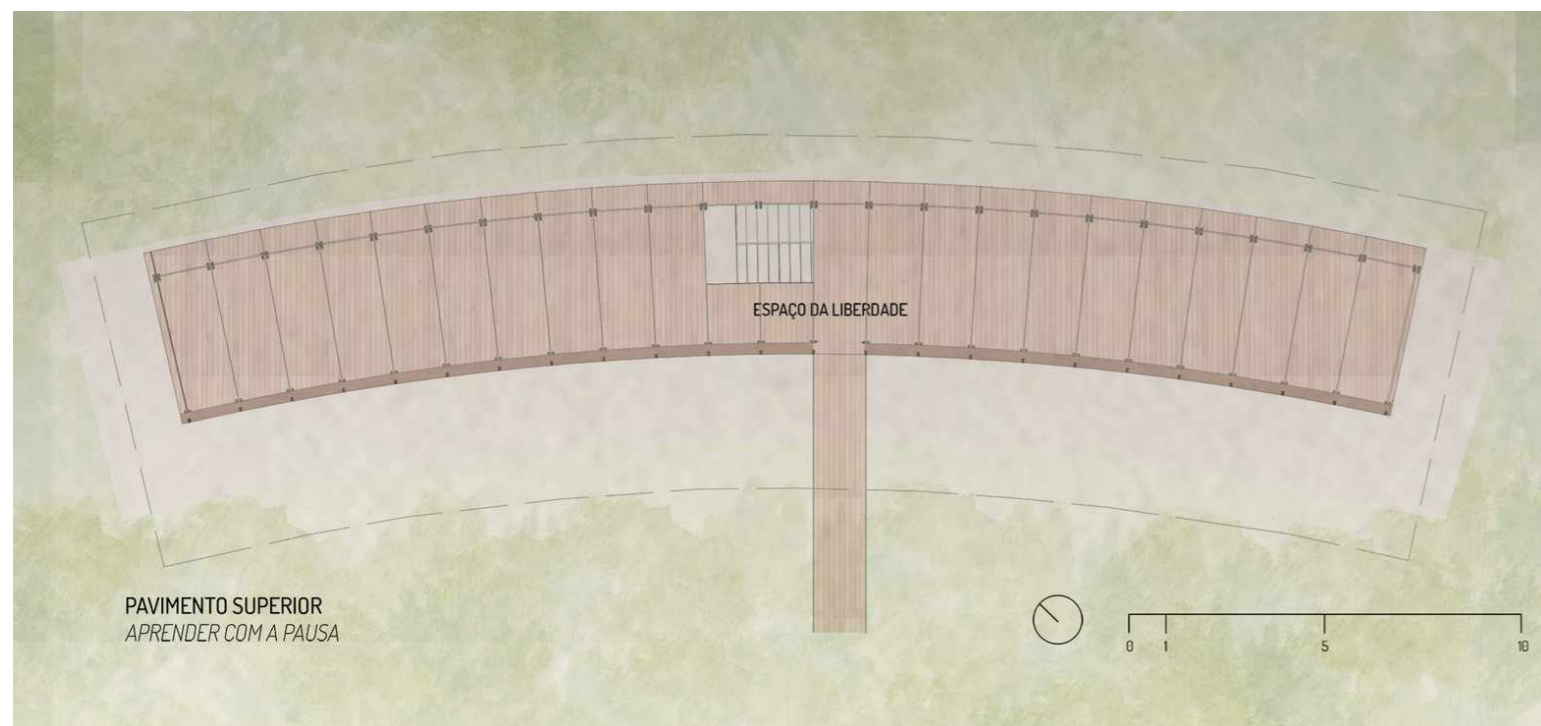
Pavimento superior Pavilhão de Oficinas.
